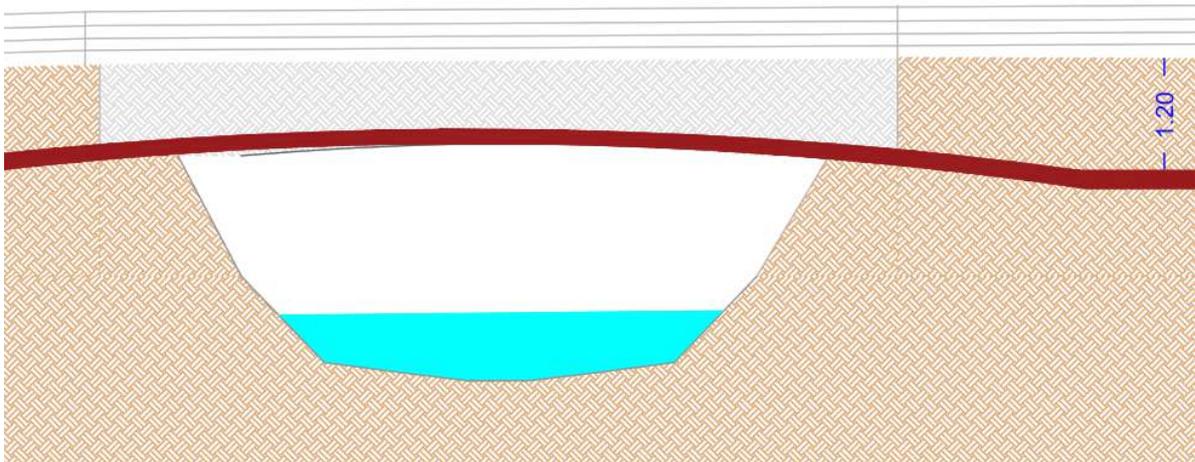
Tipico Passaggio in spalla al ponte
